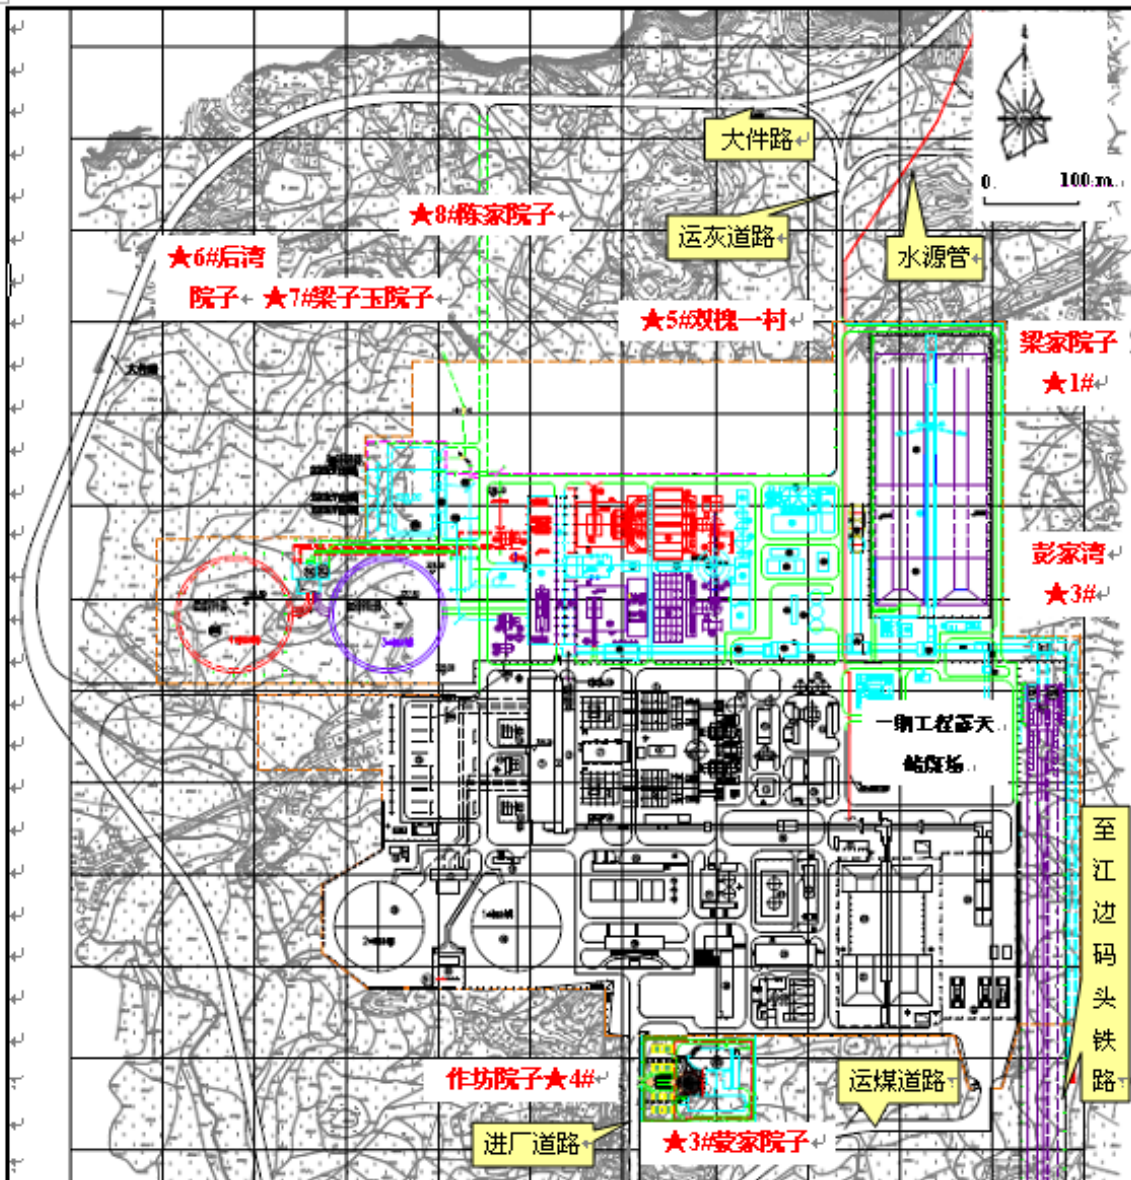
双槐电厂总平面布置图 (★为噪声敏感点)
